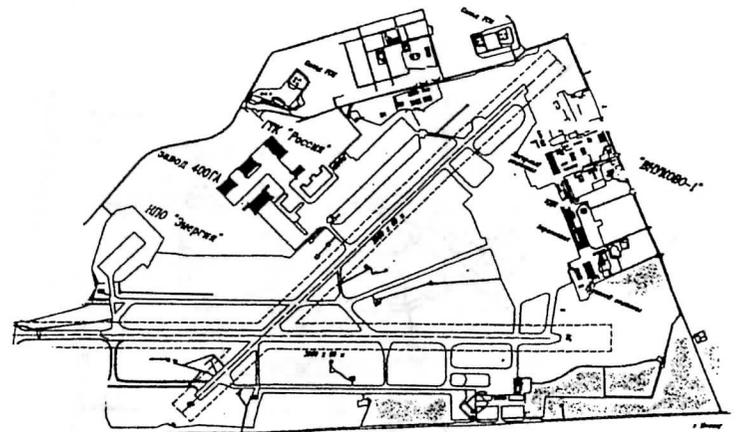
Схема генплана международного аэропорта Внуково с перекрестными ВПП
